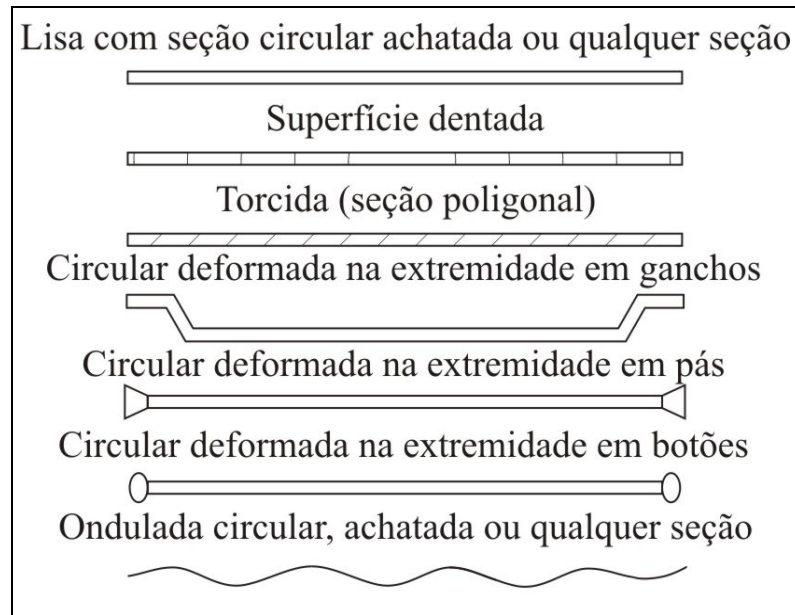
Configurações típicas das fibras de aço empregadas em concreto (NAAMAN, 2000).
